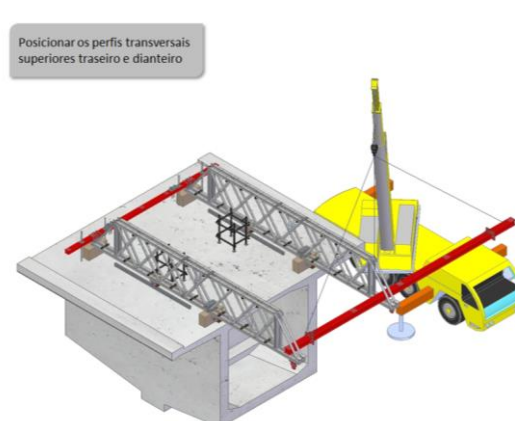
Posicionamento de perfis transversais superiores
